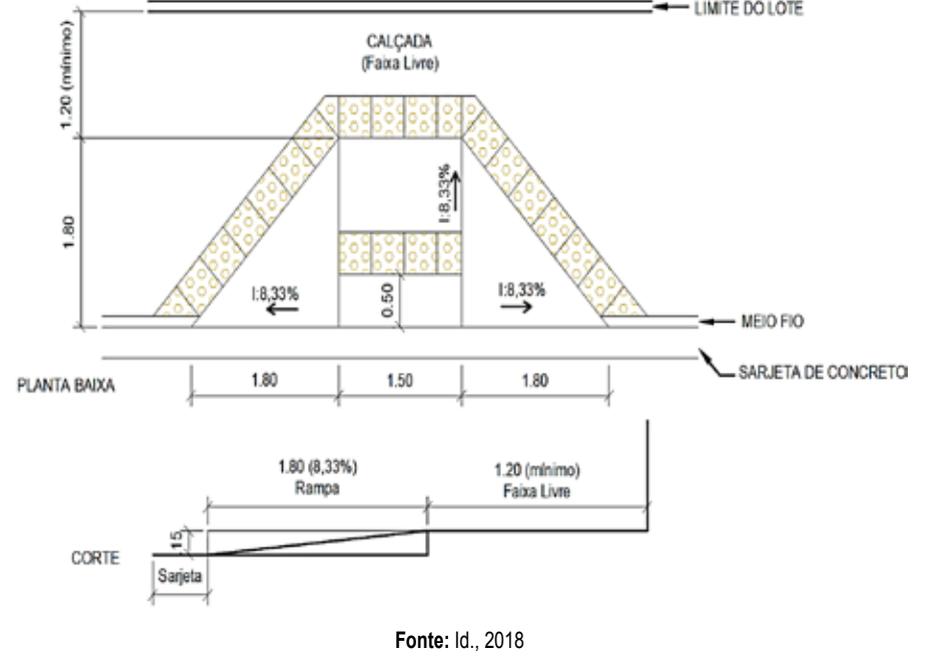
Planta baixa e corte da rampa transversal para calçada com altura de 10 cm
